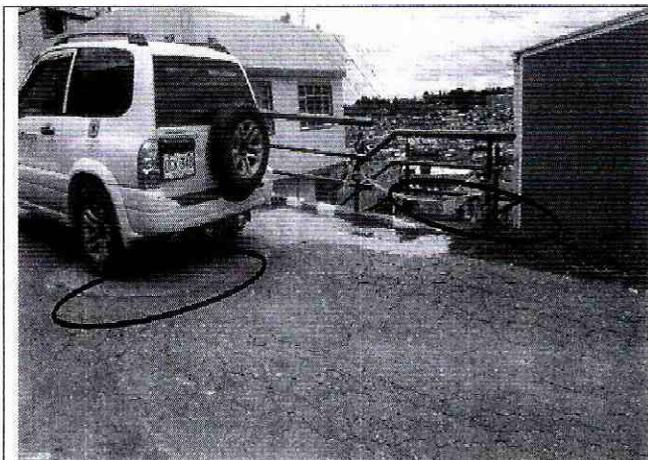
Separación lateral de los escalones del muro en concreto y grietas de abertura cercana a dos (2) centímetros.
